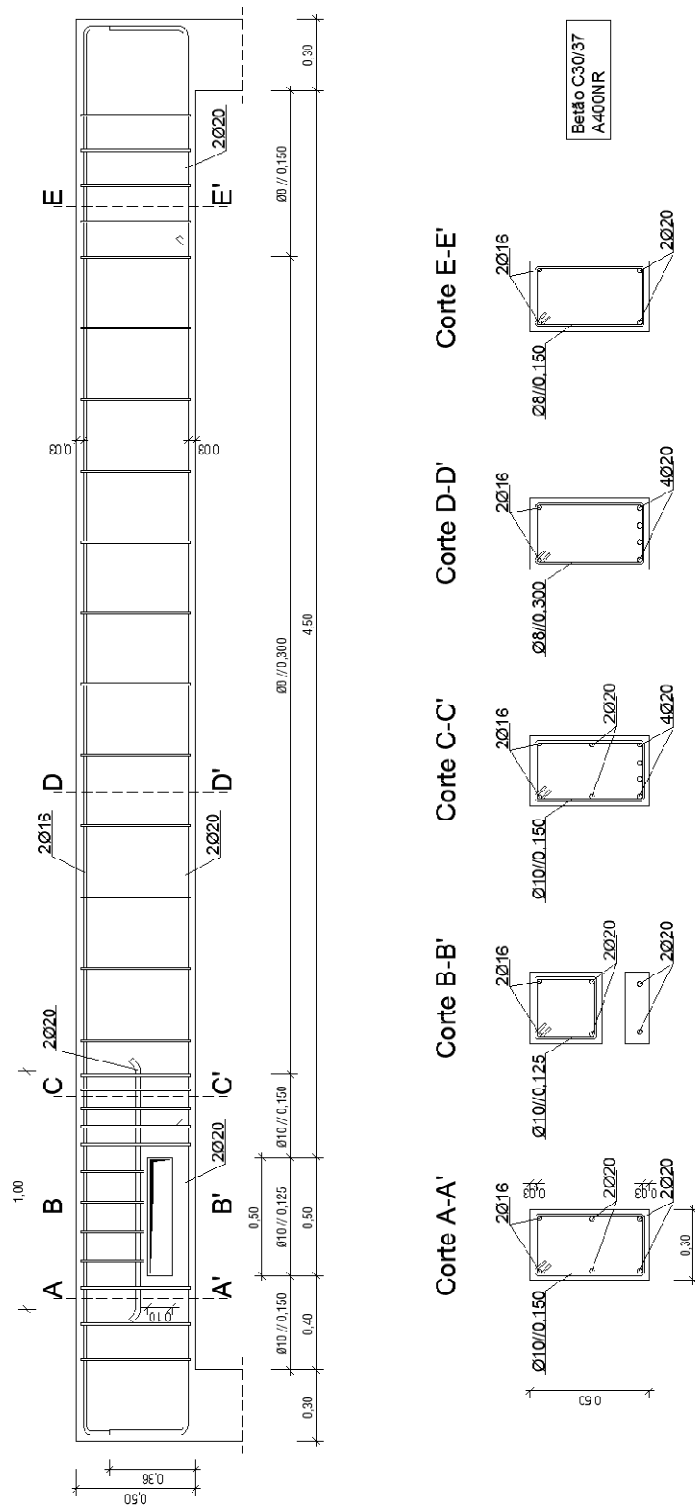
Proposta para distribuição da armadura e respetivos cortes transversais da viga.
